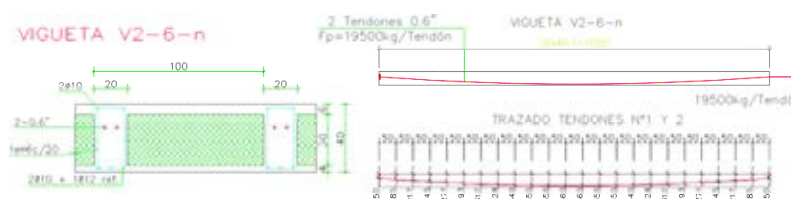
Sección y trazado de postensado para una vigueta tipo de 12 m de luz.
